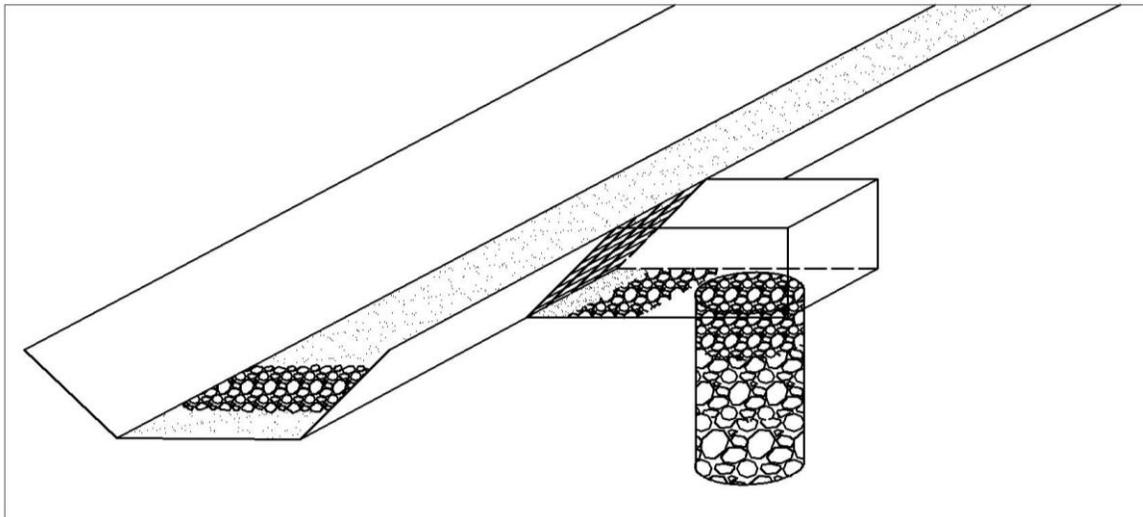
Perfil de los elementos: canal, zanja y pozo de infiltración
